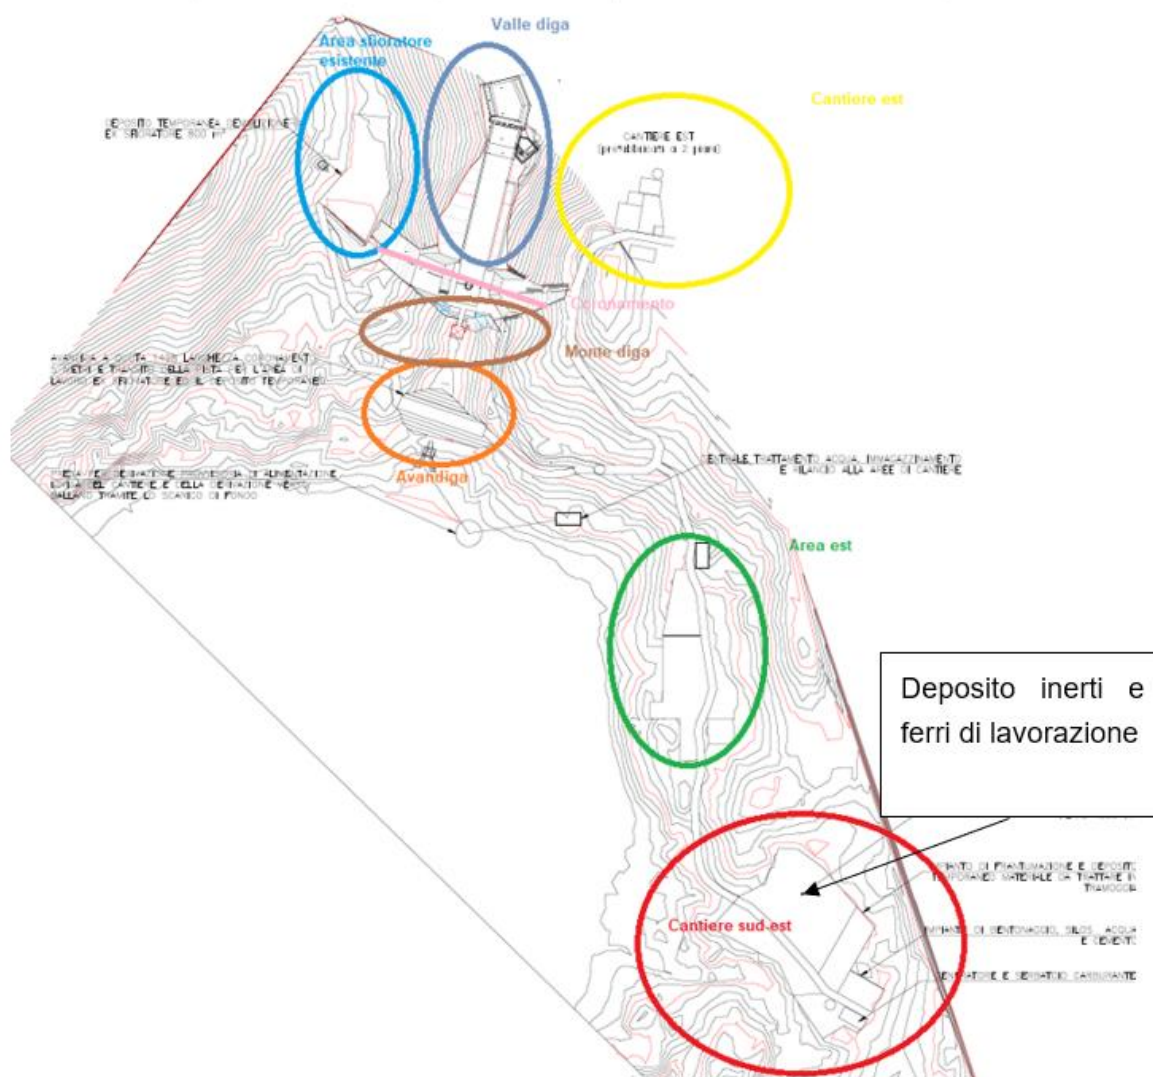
Stralcio della tavola D229 – ipotesi di cantierizzazione diga di Lago Verde
